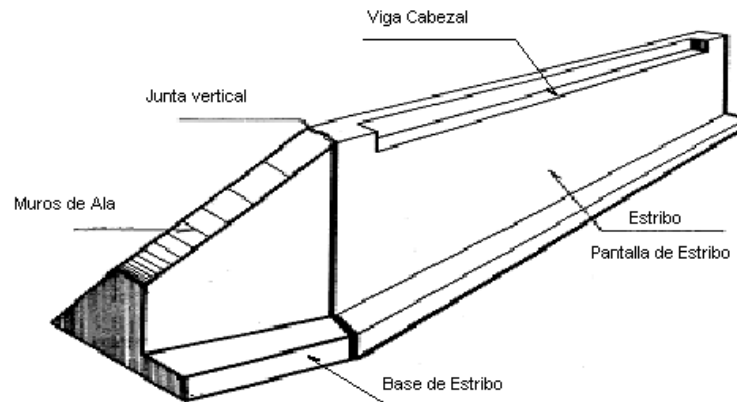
Junta vertical entre estribo y muros de ala.
